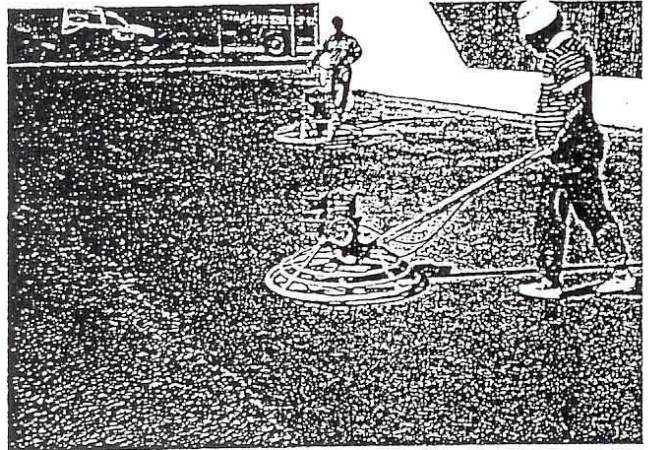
Arremolinada mecànica de la superfície del formigó amb "helicòpter".
